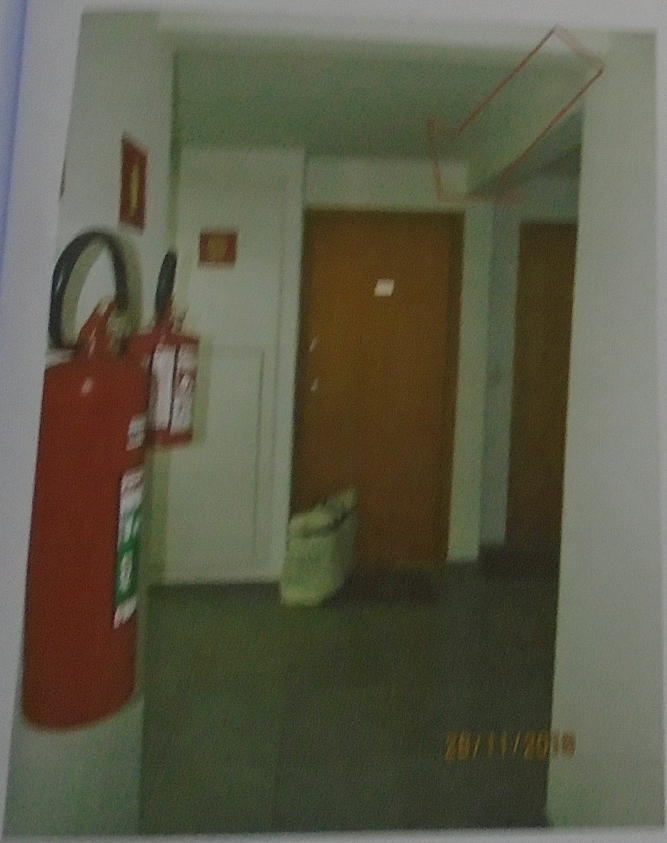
Vista da porta de entrada da unidade objeto, nº 1006, no 10º andar do edifício.
